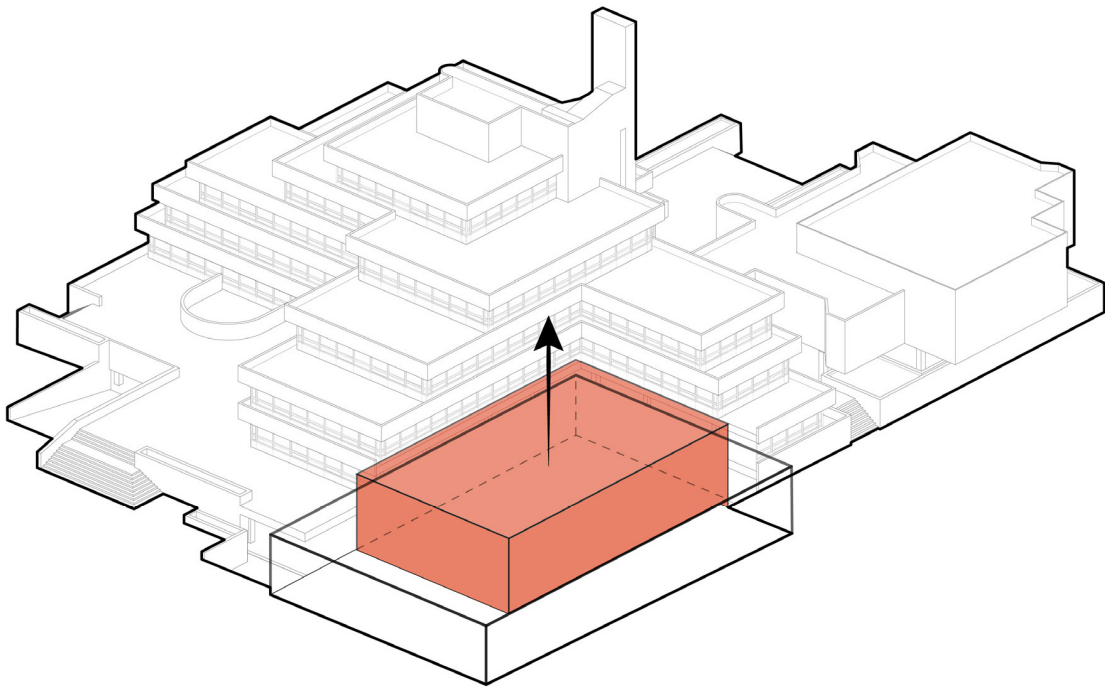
Planungsvariante Bürgersaal und Rathausgebäude mit Orientierung zum Höveler Markt (HPP Architekten)
